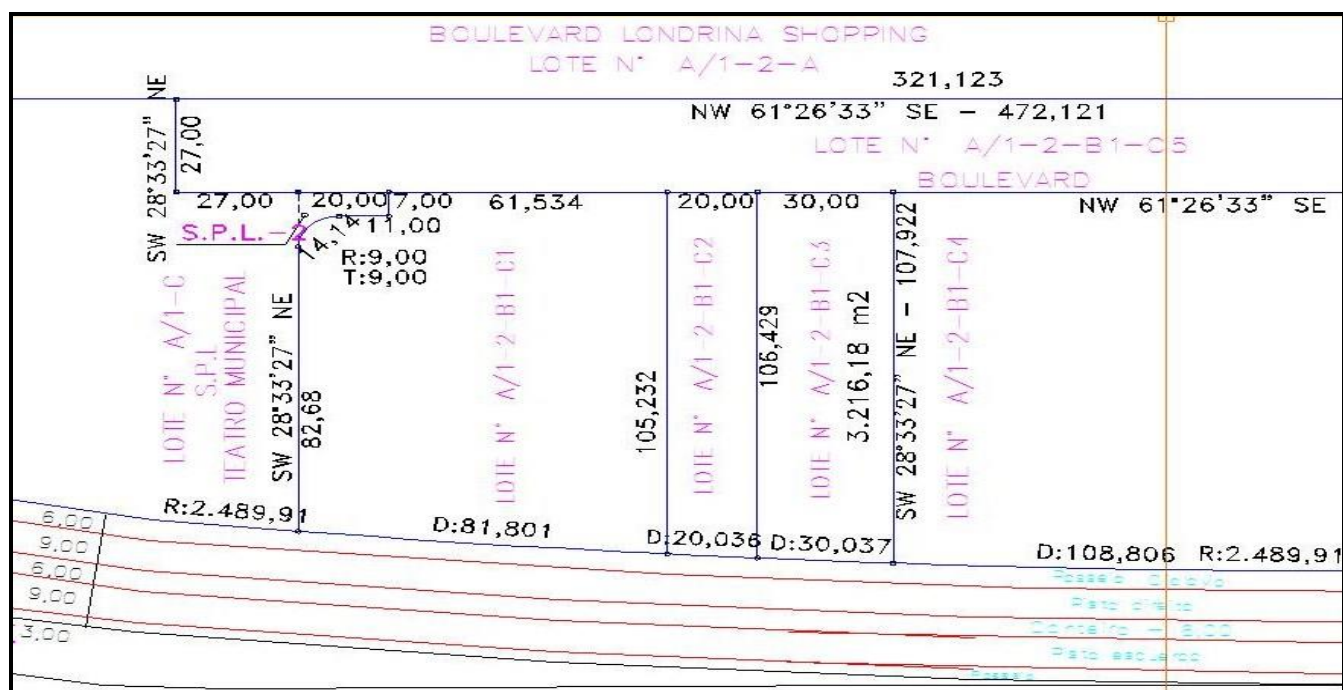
Planta de Subdivisão do Lote A/1
